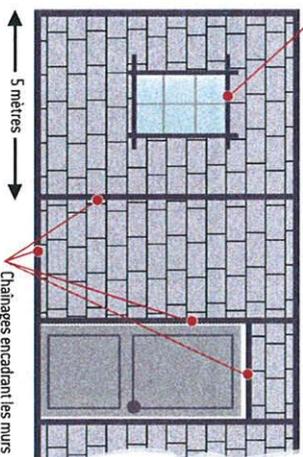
Ajout de chaînages horizontaux et verticaux encadrant les maçonneries (élévation)
